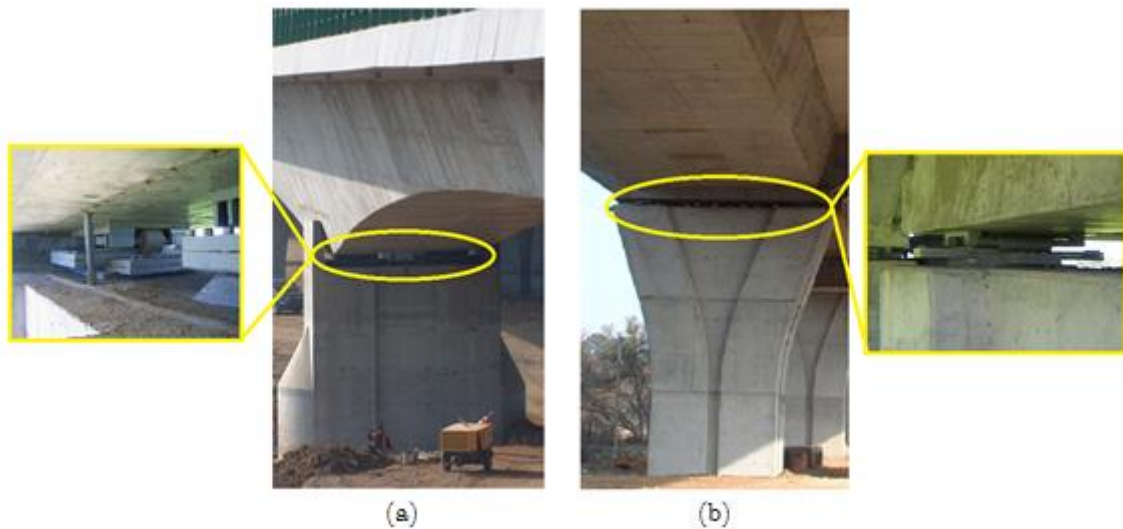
(a) Aparelhos de apoio dos pilares intermédios; (b) Aparelhos de apoio dos pilares de transição.
